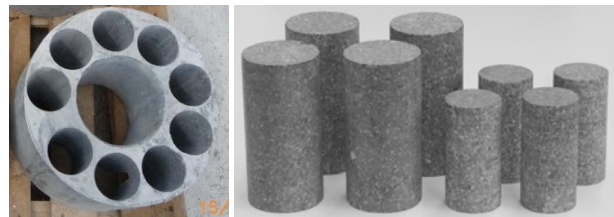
Schleuderbetonbauteil (links) und entnommene Bohrkern (rechts)
